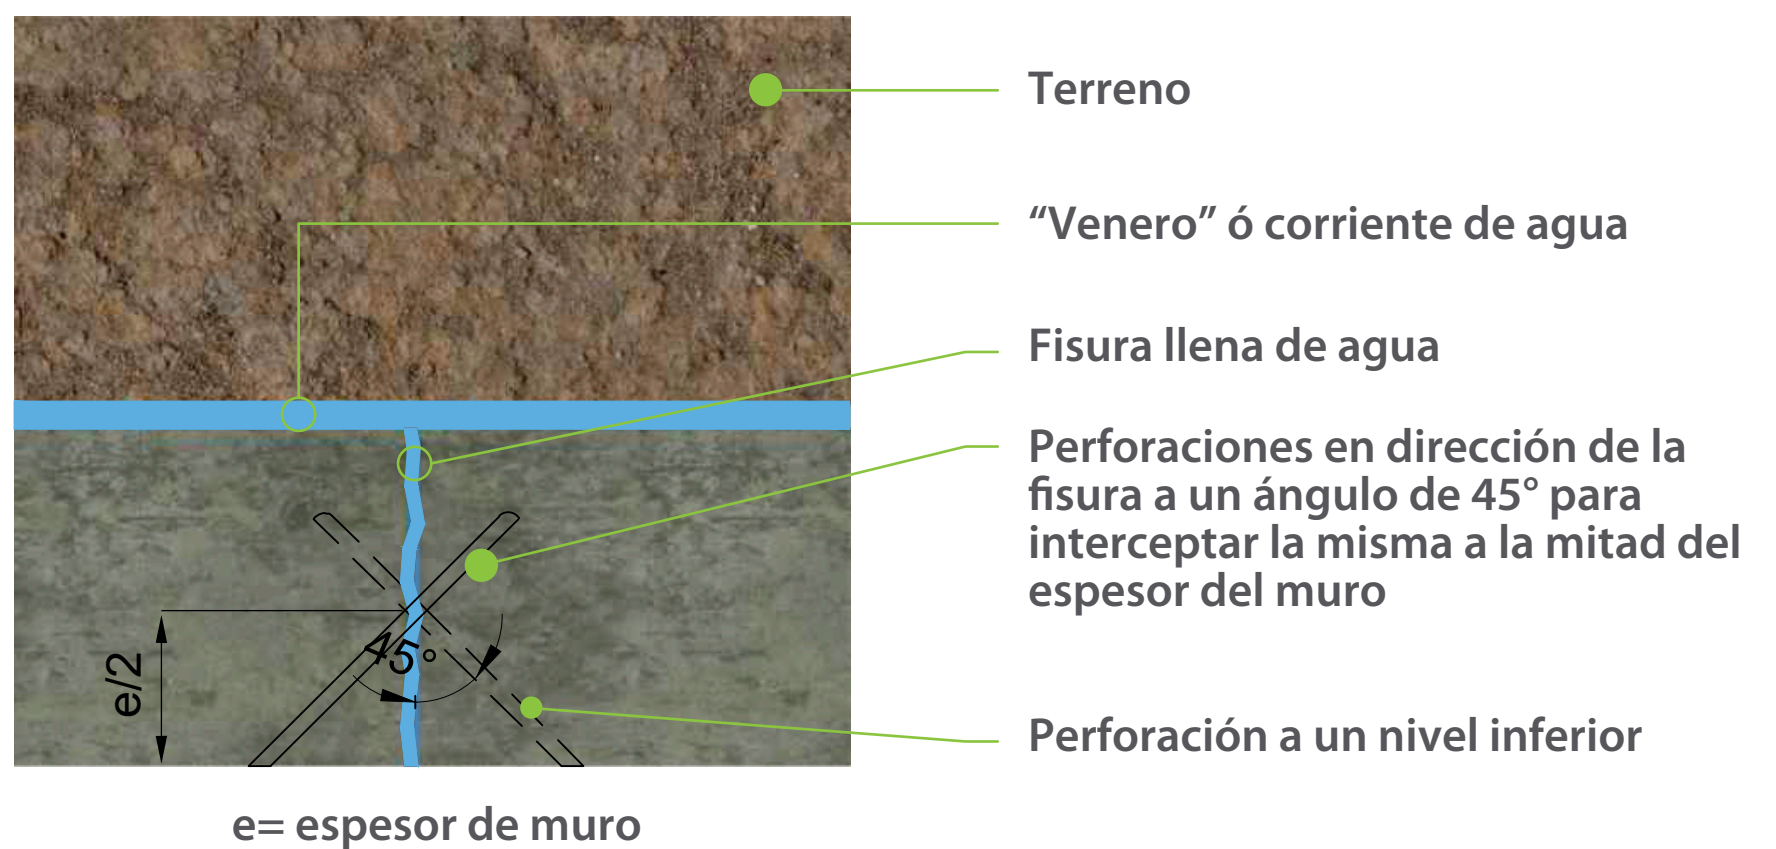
Vista en corte superior - Estado inicial de la fisura con entrada de agua.
